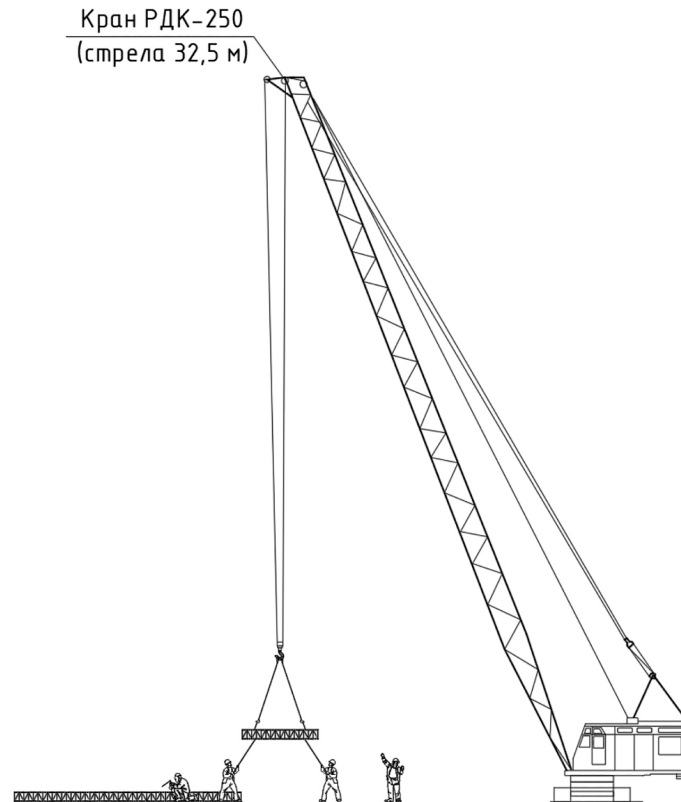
Подача и сварка элементов арматурного каркаса
